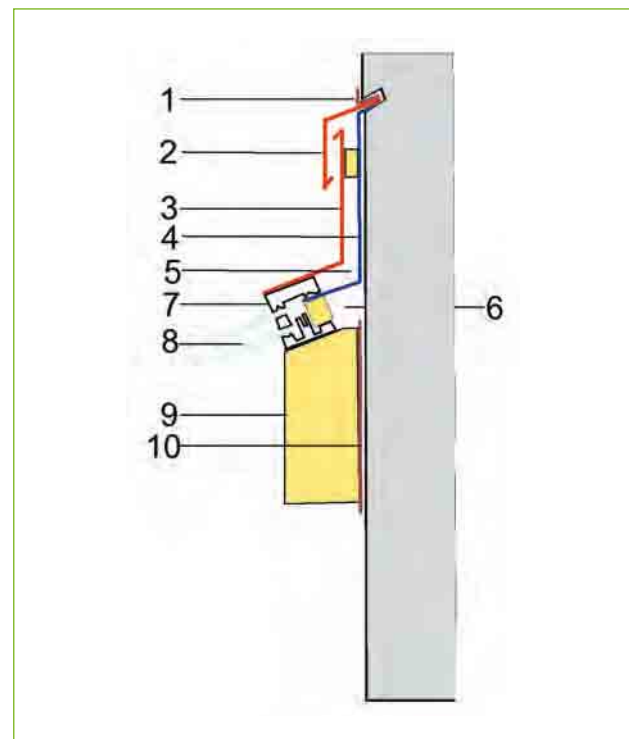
Wandanschluss, Schnitt: 1) Abdichten, 2) Überhangprofil, 3) Abschlussblech (auf Unterkonstruktion), 4) Folie, 5) Entwässerung nach außen, 6) Hohlraum hinterlüften, 7) Trockenverglasungsprofile, 8) transparente Abdeckung, 9) Pfette, 10) Dämmung.
